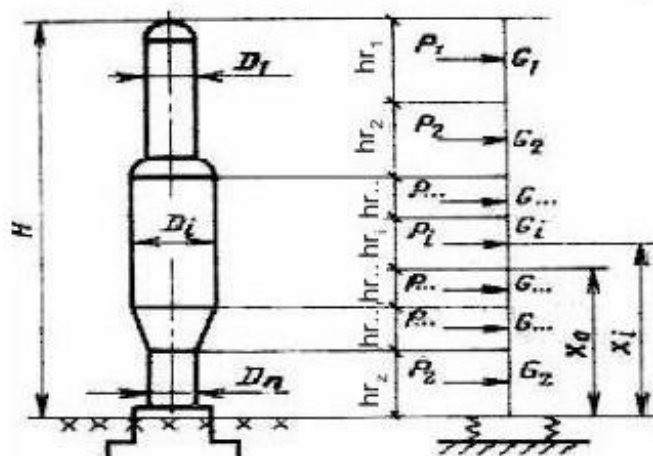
Расчетная схема аппарата колонного типа для определения ветровой нагрузки.
